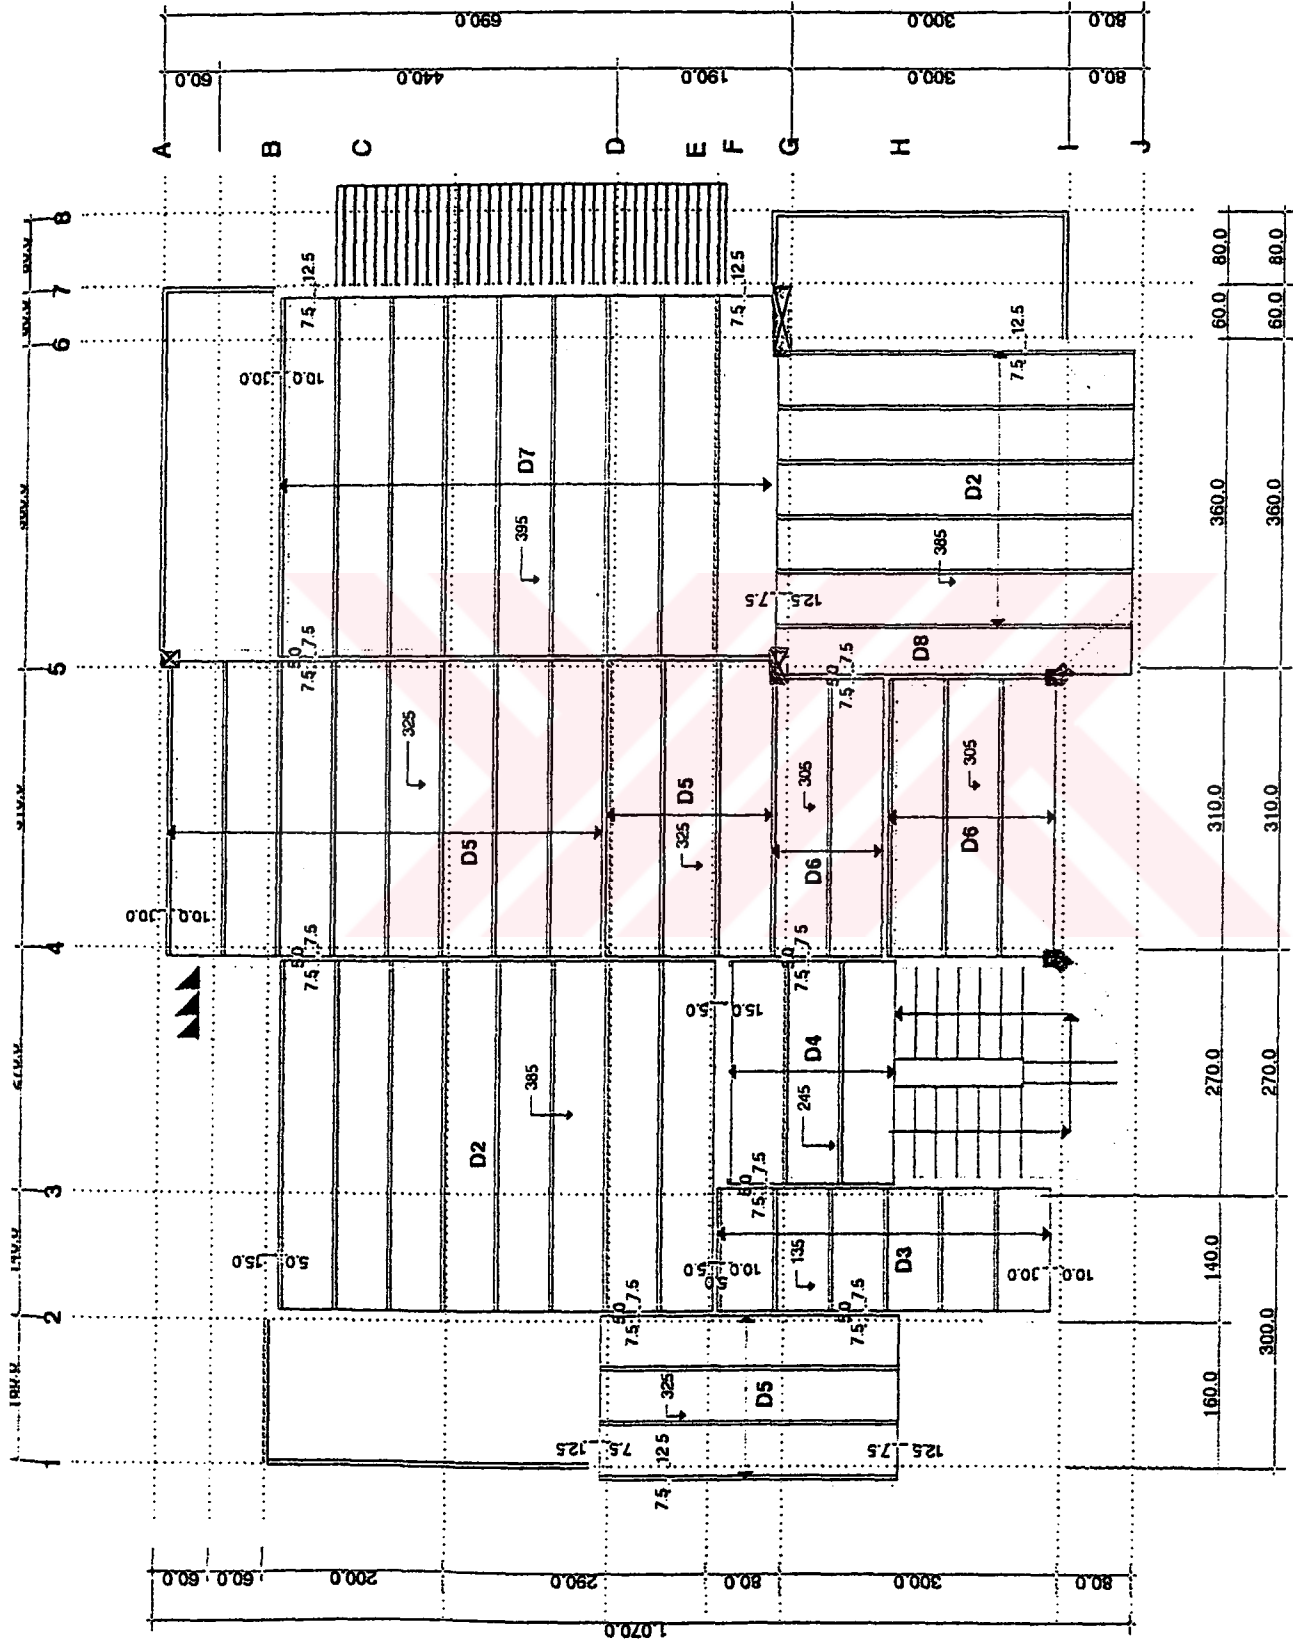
1. Kat Planı (Dönüşümden sonraki proje)
